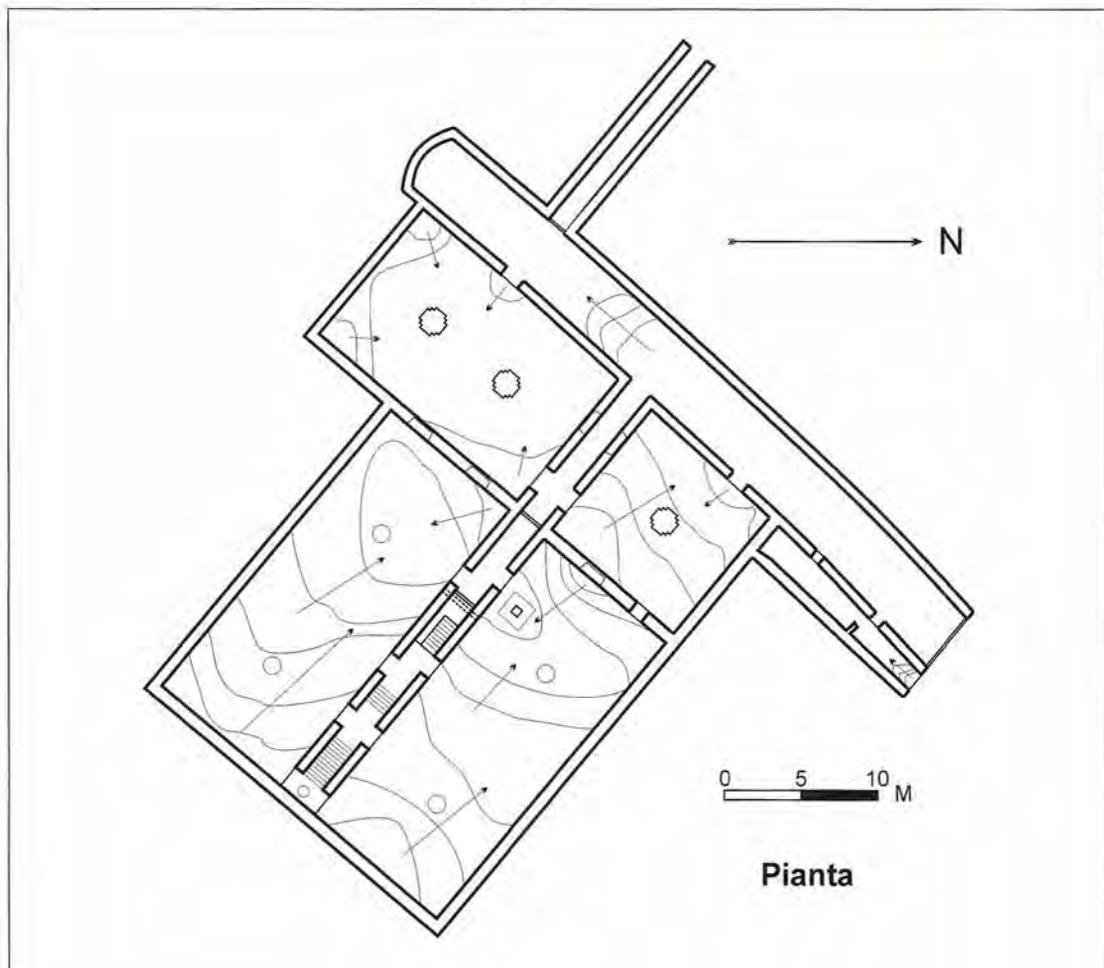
planimetria della Ghiacciaia di Piantelli (grafica A. Verrini).
